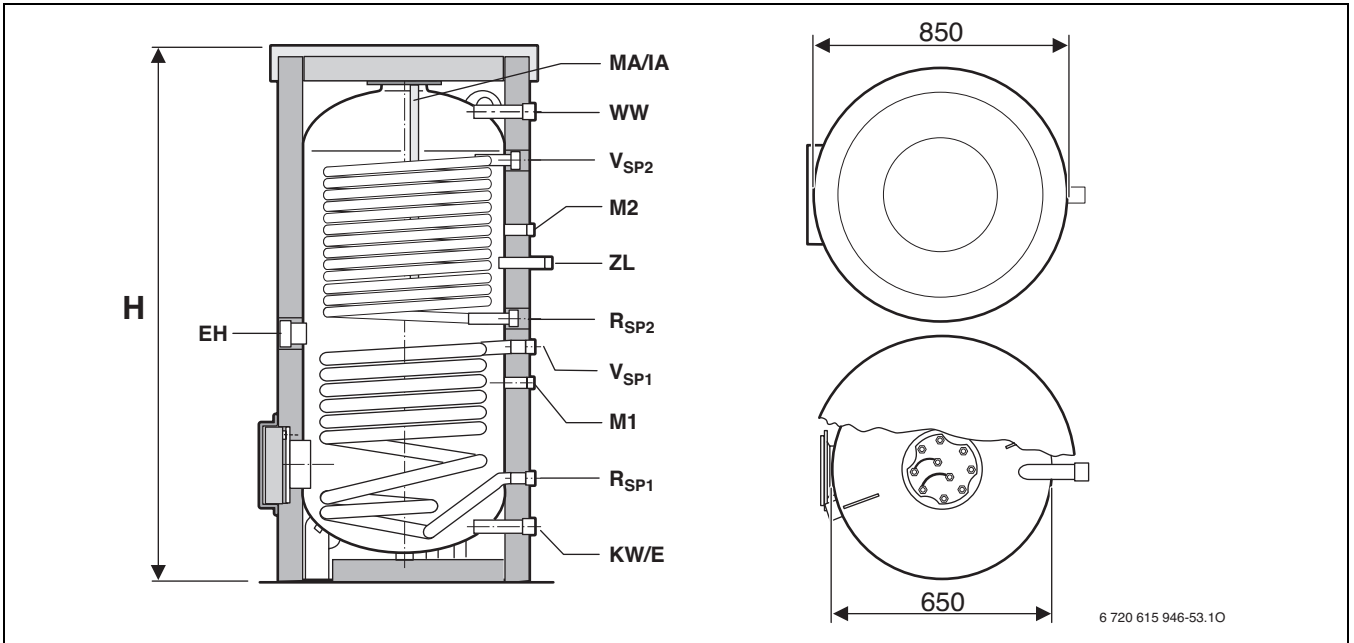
Bau- und Anschlussmaße der Solarspeicher SW 400-1/SW 500-1 solar (Maße in mm)
